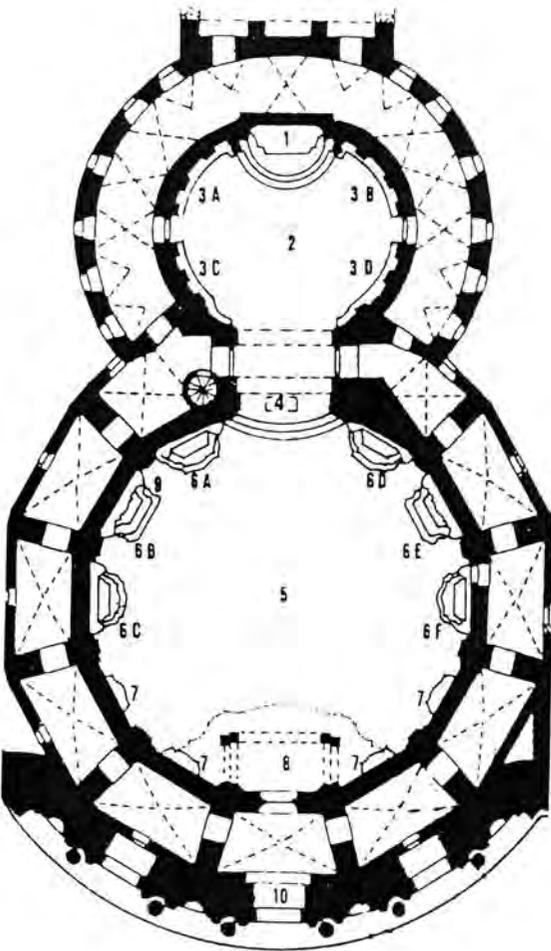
Klosterkirche Ettal, Grundriss mit Hauptkuppel und Chorkuppel
